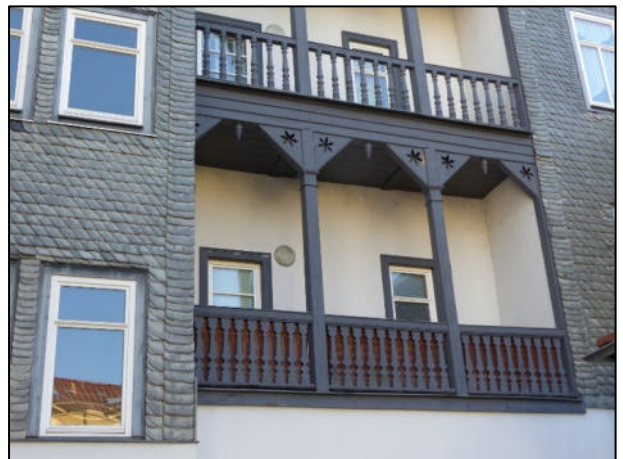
Detailansicht – Balkon zur ETW Nr. 4
